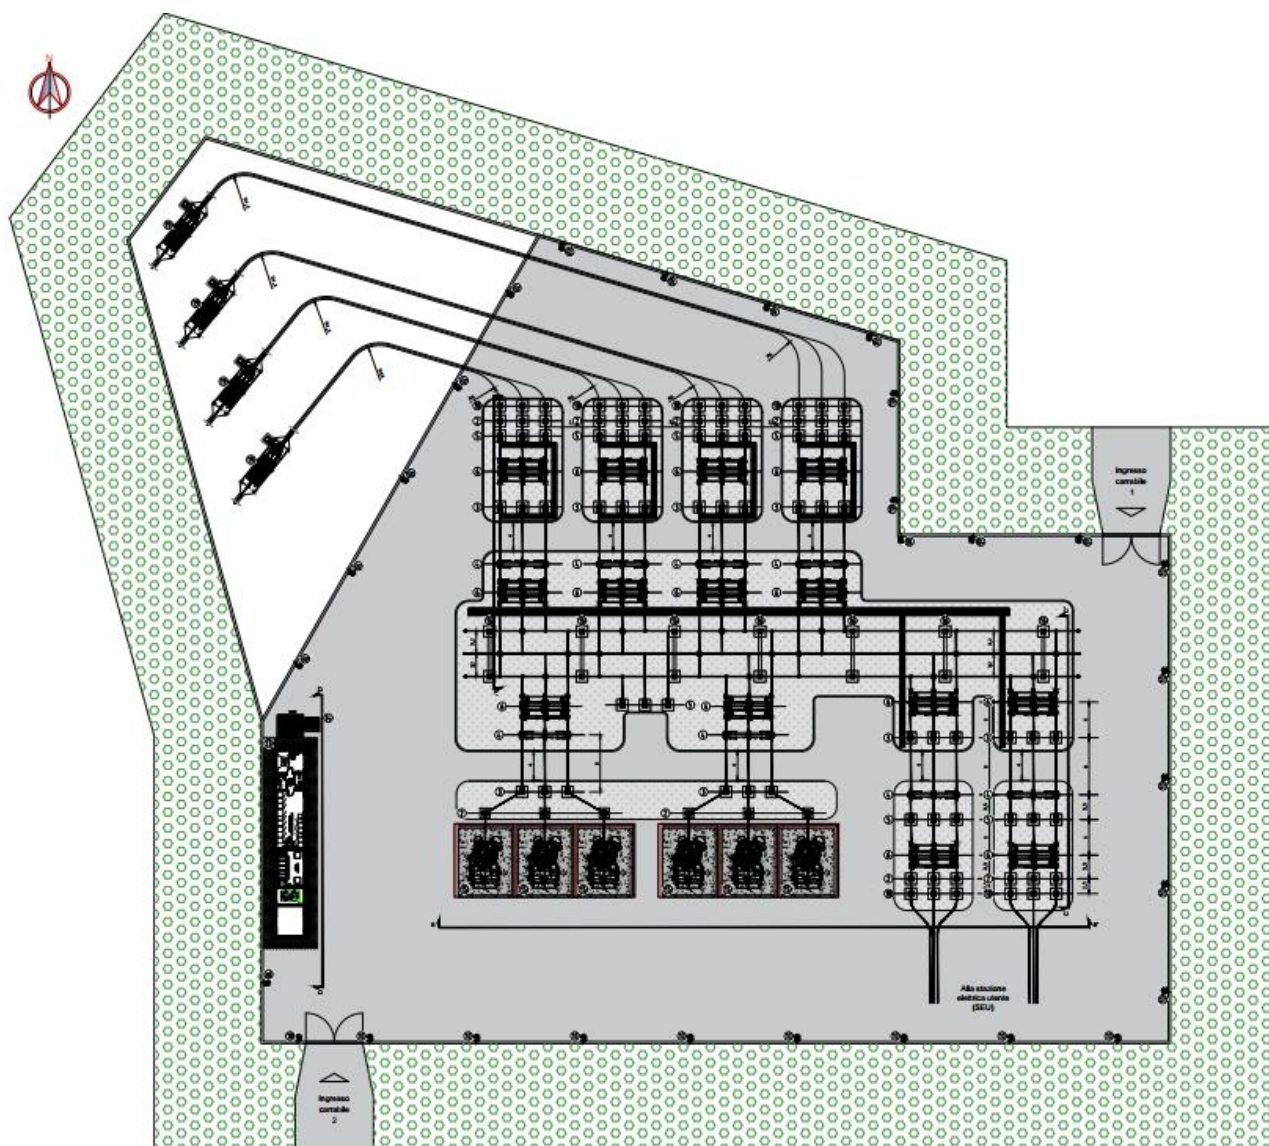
Planimetria area della stazione utente (fuori scala).
